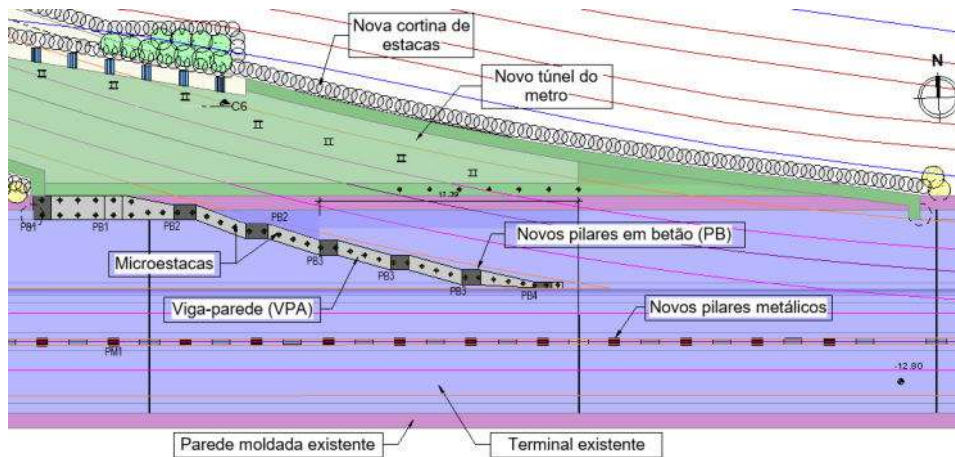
Planta de Dimensionamento da Fundação da solução Definitiva do Terminal Sobre estas microestacas foi executada uma viga de parede (VPA), destinada à distribuição das cargas provenientes dos novos pilares em betão armado (PB) (Figura 13).
